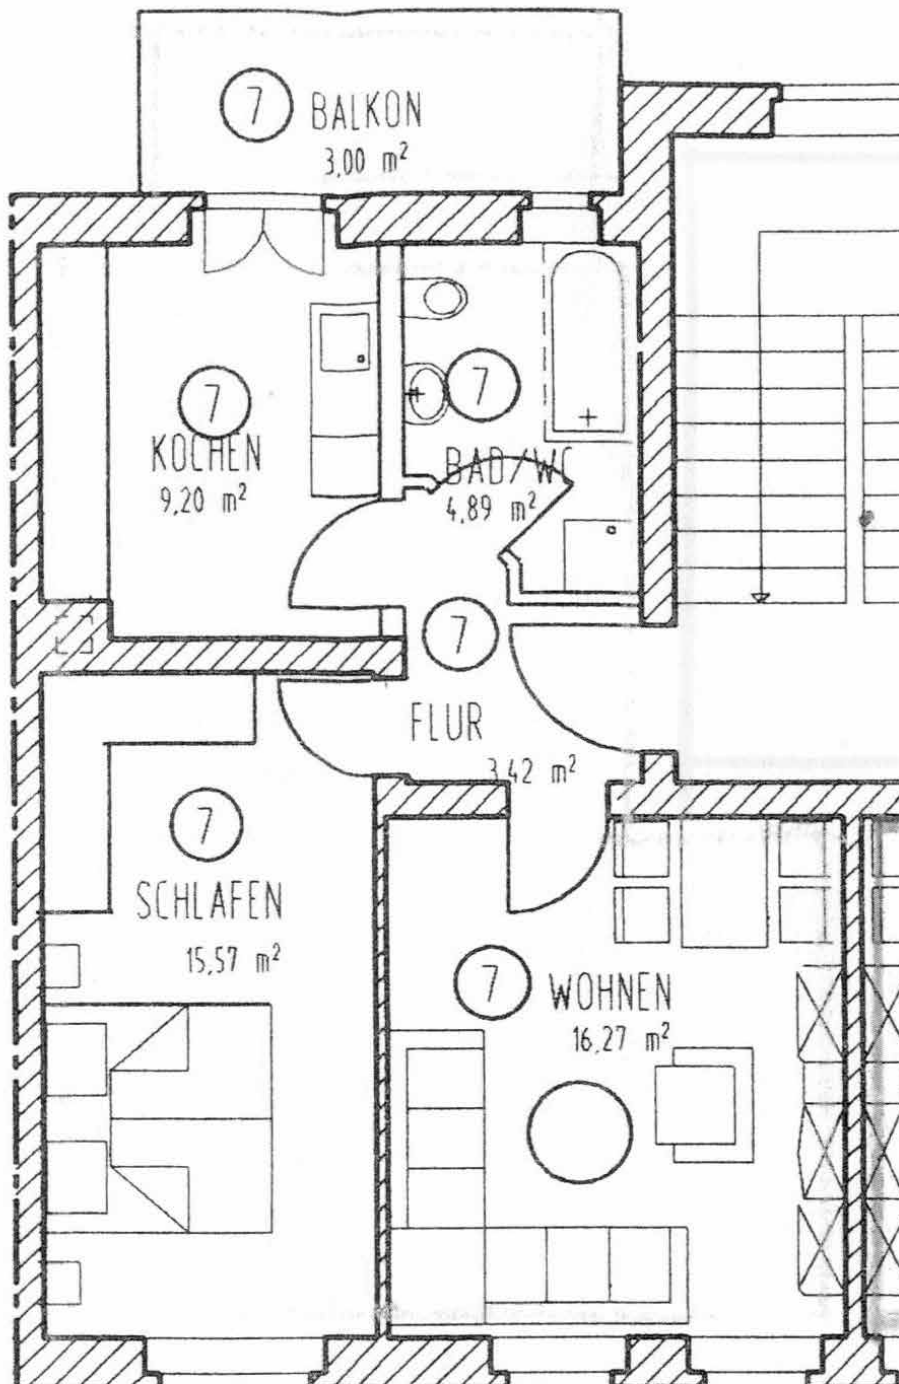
Grundriss der Wohneinheit Nr. 7
